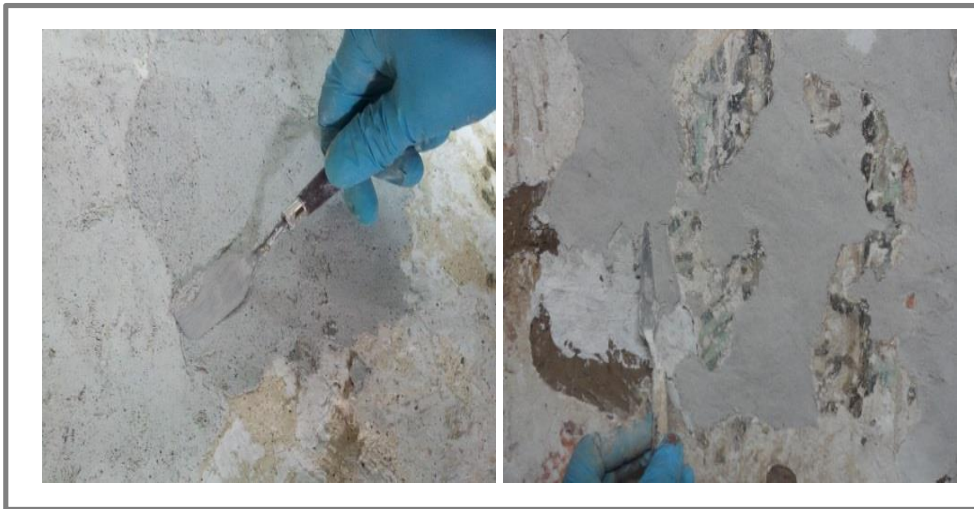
Aplicación del mortero cálcico con diversas espátulas
